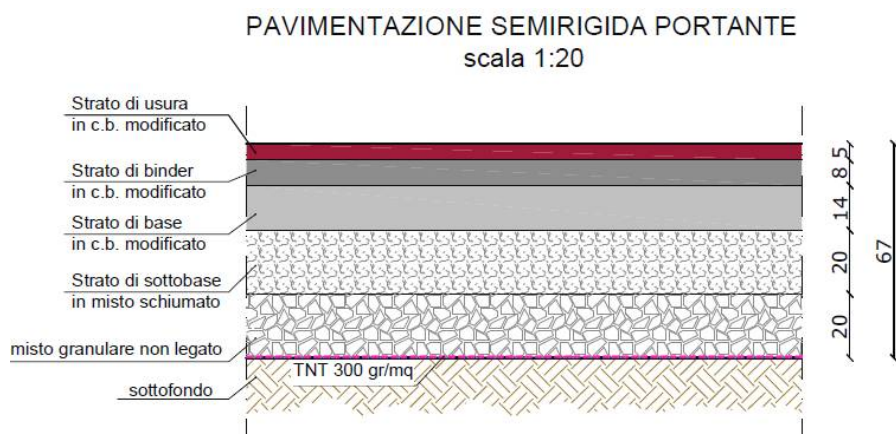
Pavimentazione di progetto nelle aree a maggior carico
